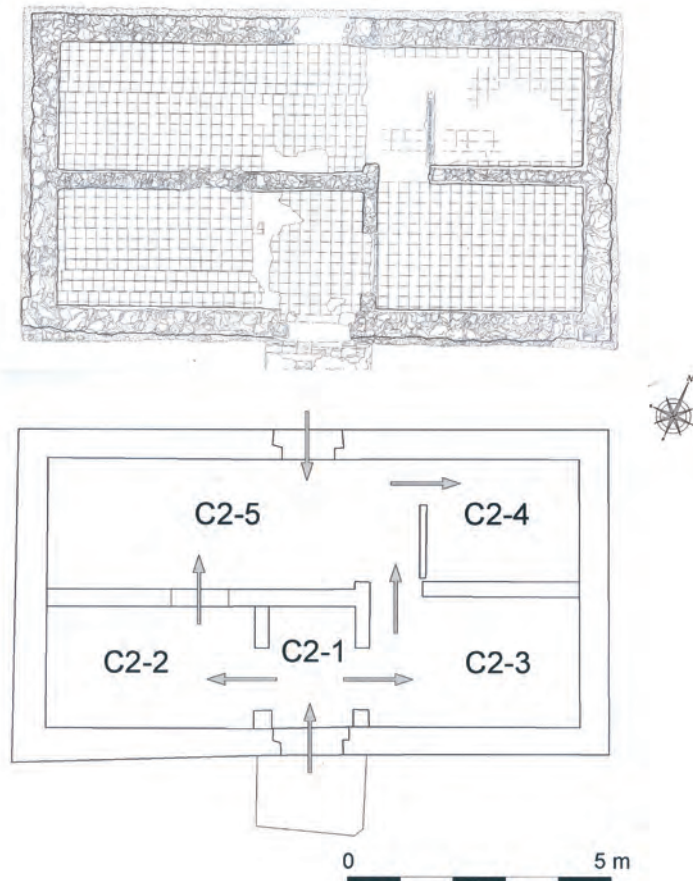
Croquis distribución edificio C-2. Planta excavación.
